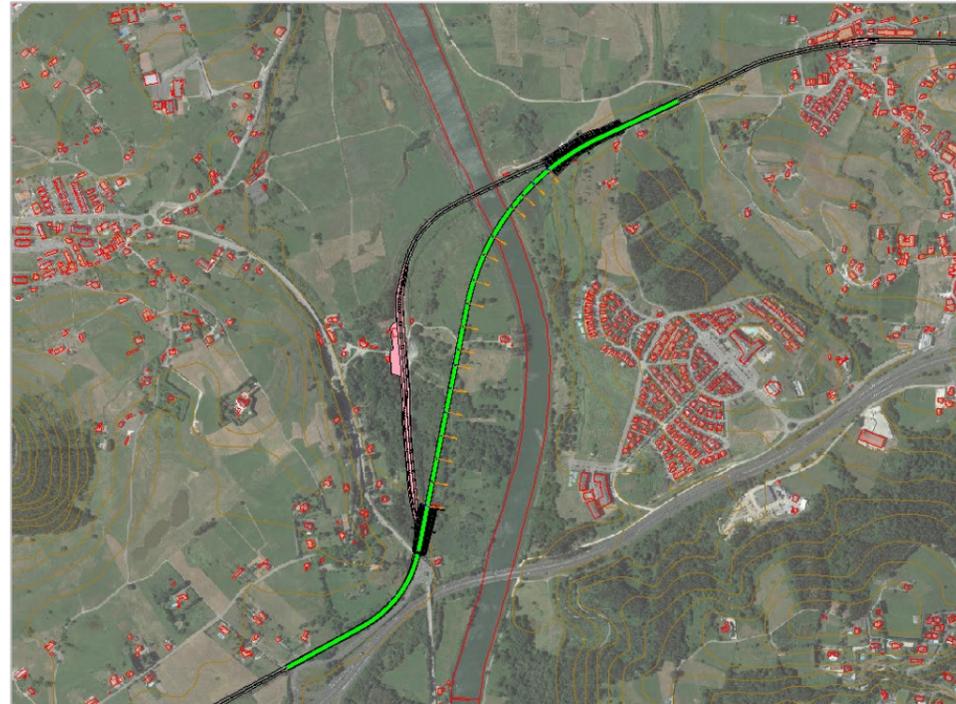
Trazado en planta entre Mogro y Boo de Piélagos. Fuente: Autor
